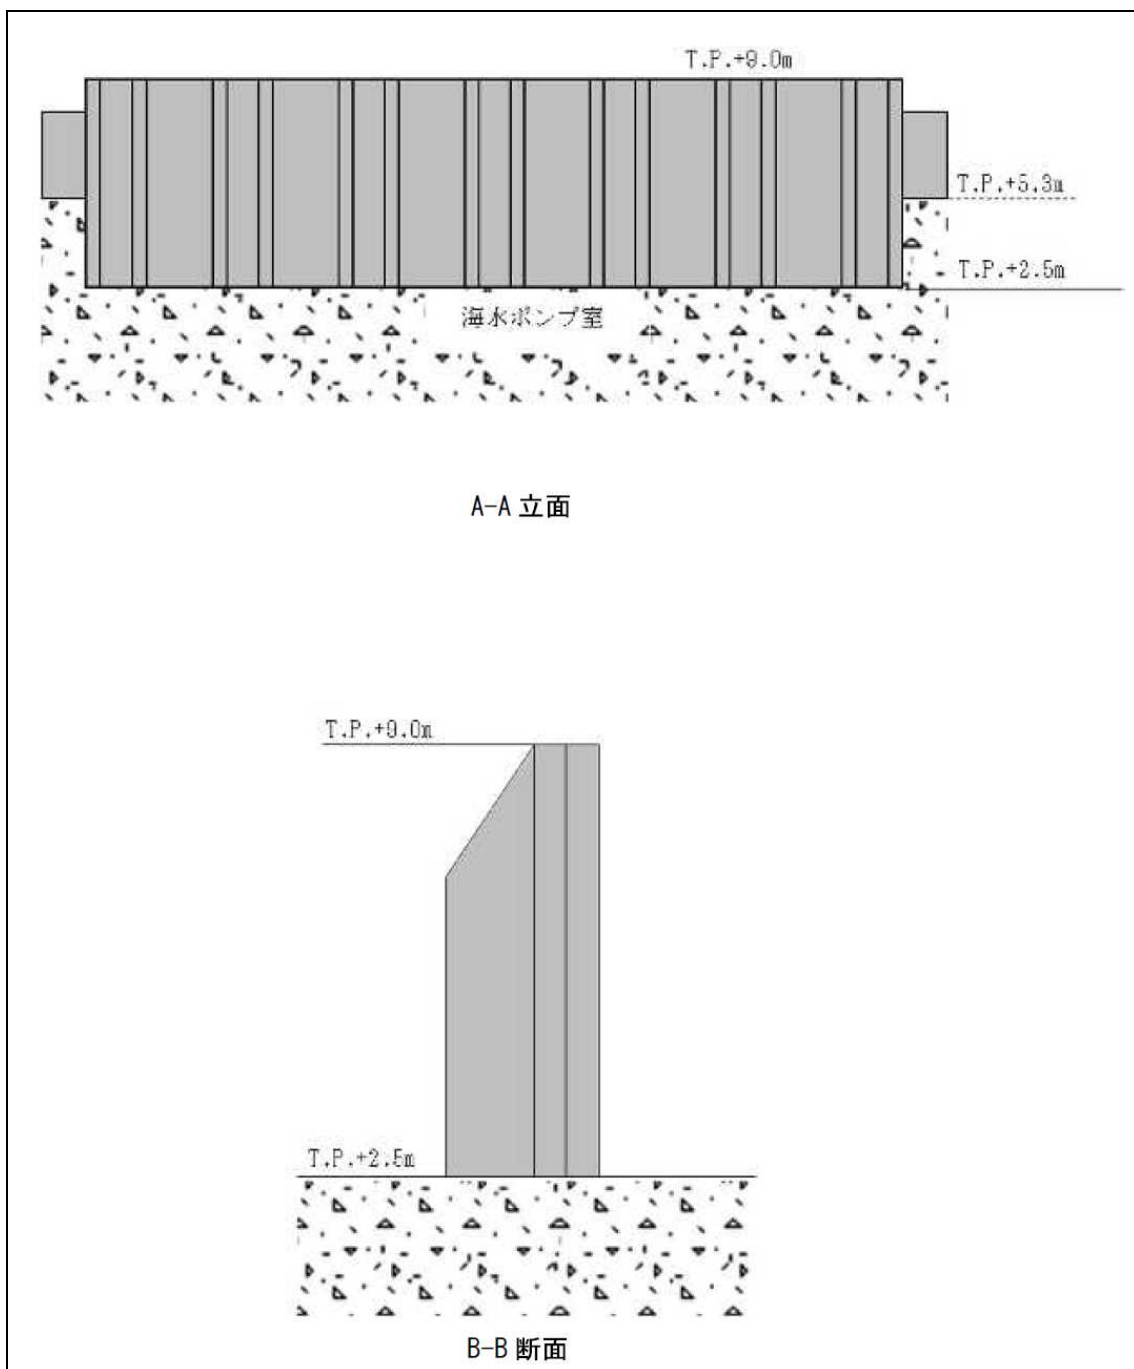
止水壁立面図及び断面図 (1/2) (関西電力 大飯 3, 4 号炉)
